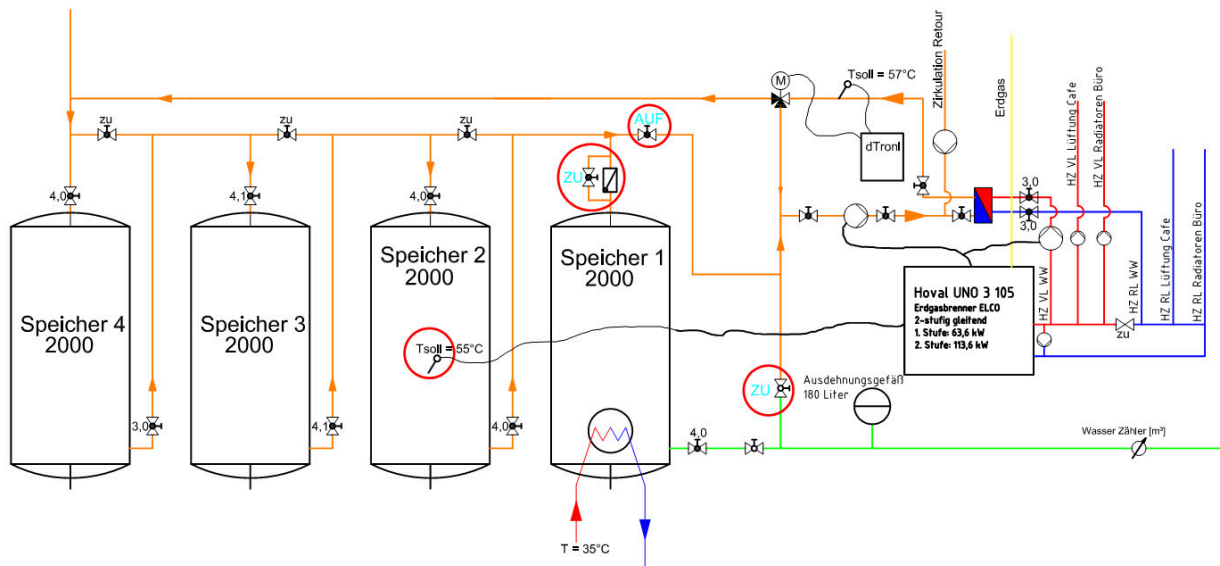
Schema Warmwasserbereitung nach dem Umbau - Ladung der Speicher
